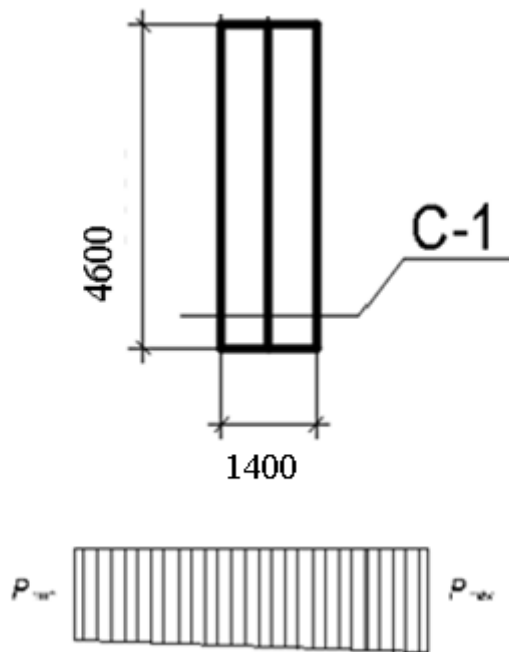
Дов. визначення перерізу арматури плитної частини фундаменту
